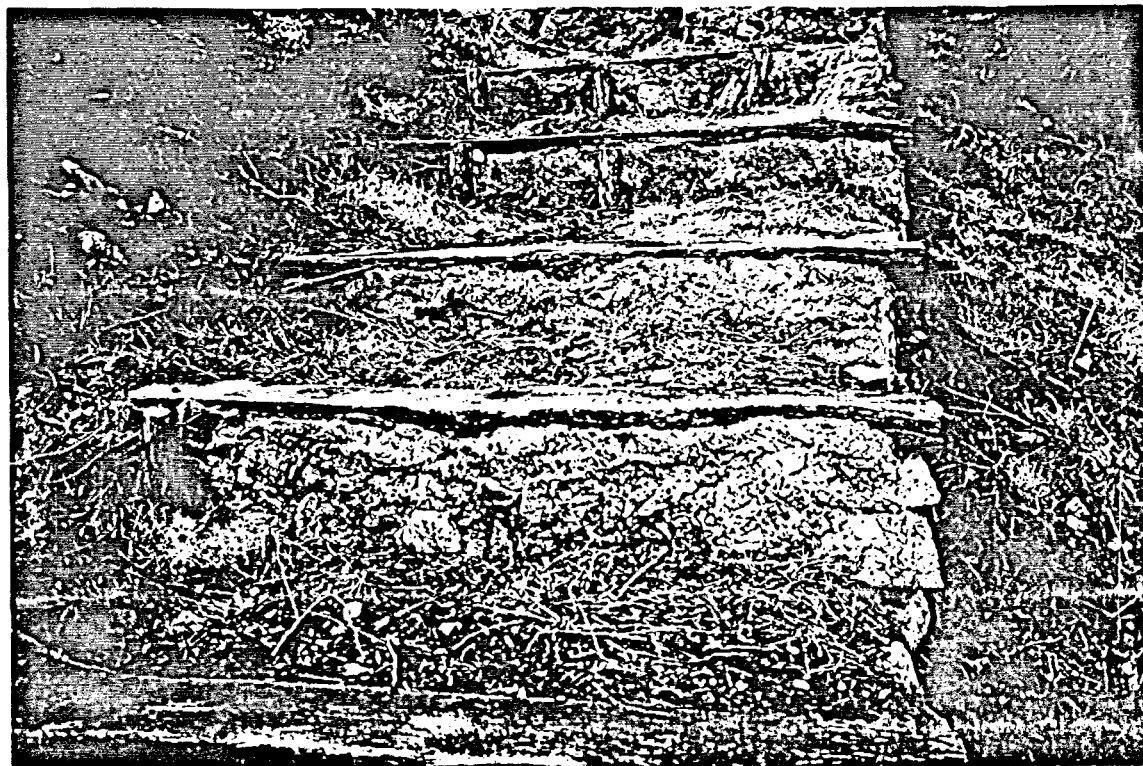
Foto de paviment d'una escala amb fusta i pedra Tamariu. Palafrugell.
